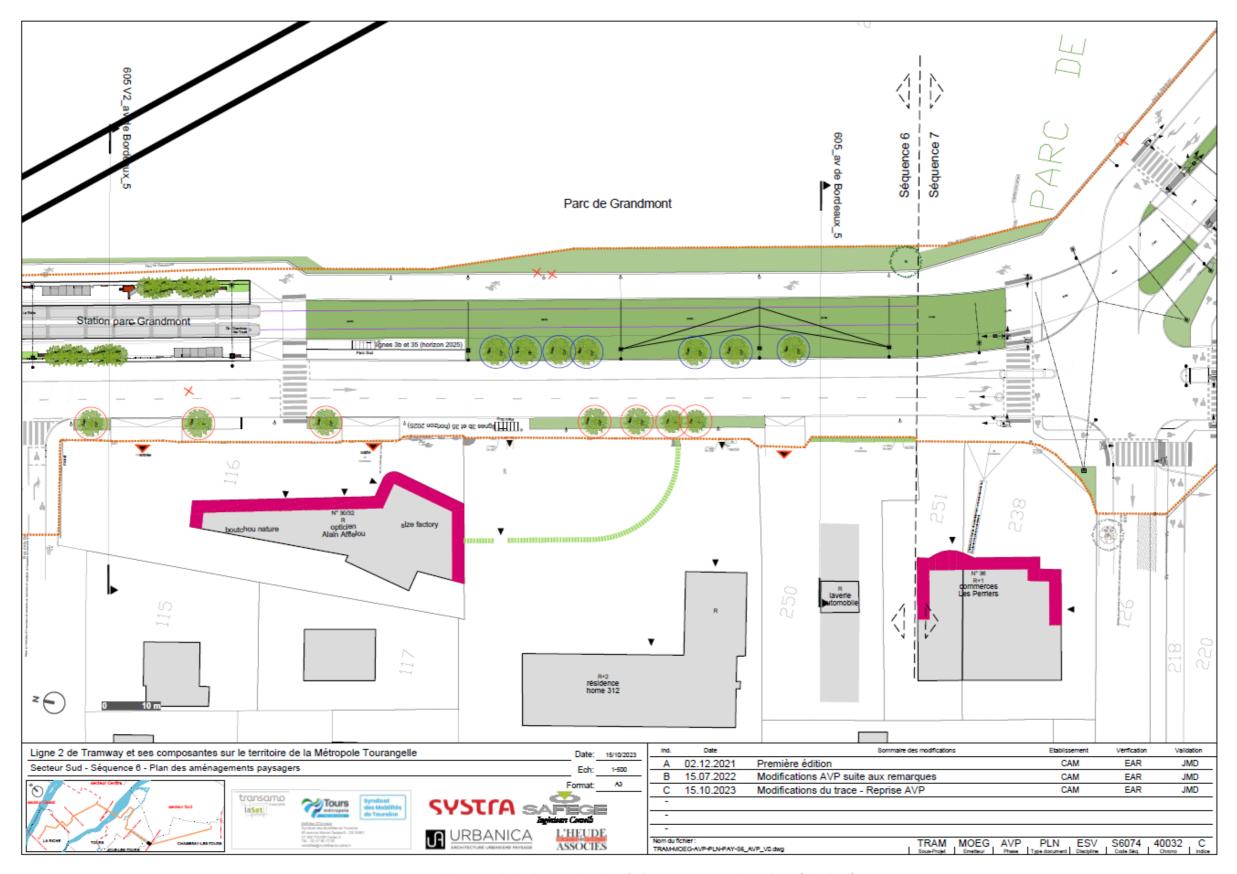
plan masse de localisation des arbres à abattre sur avenue de Bordeaux (planche 2)
